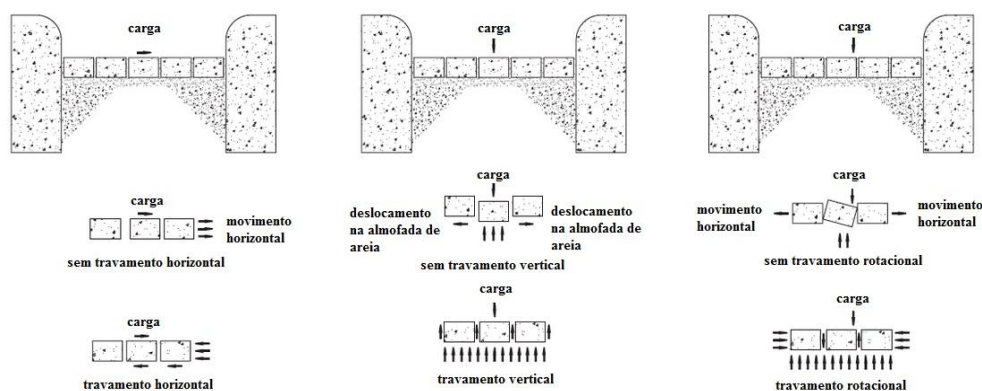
Tipos de travamento em pavimentos de BPB (Pavs14)
